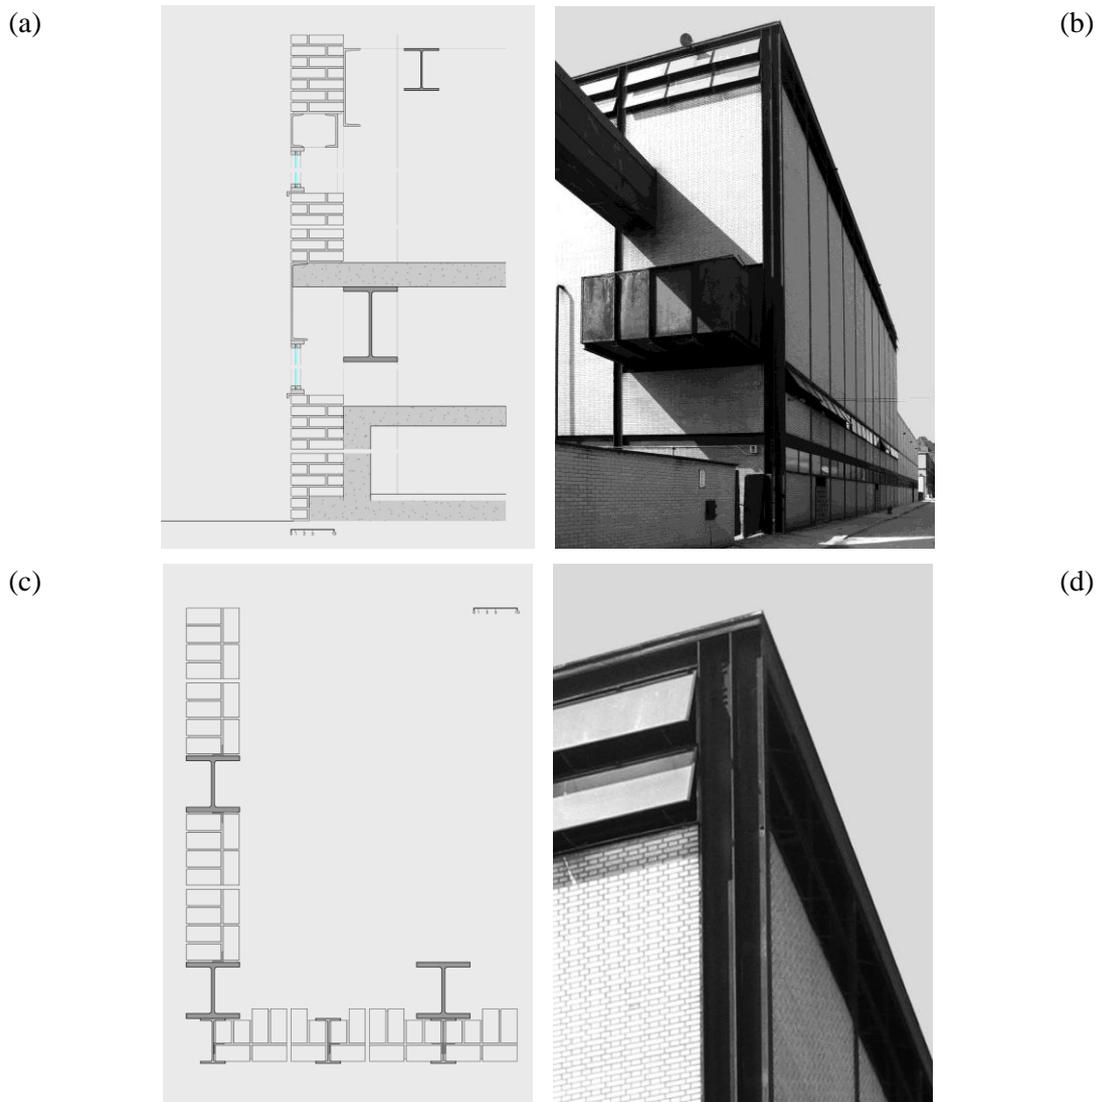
(a) Sección constructiva transversal en el alzado Este del IIT Boiler Plant, 1945-1950; (b) Alzado Este parcial del Boiler Plant; (c) Planta constructiva del Boiler Plana; y (d) Esquina Sureste del Boiler Plant.
